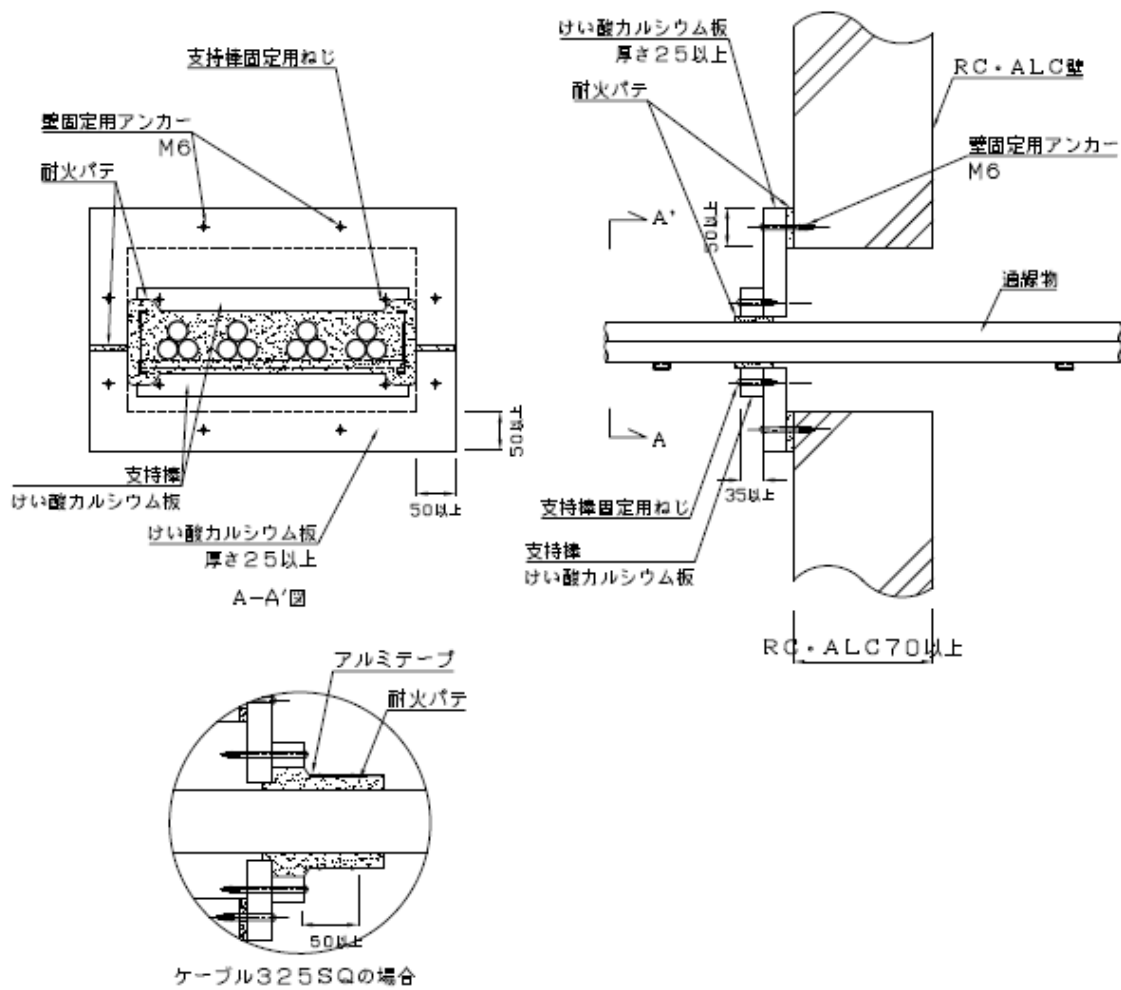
鉄筋コンクリート、ALC 壁等貫通部の標準施工図
